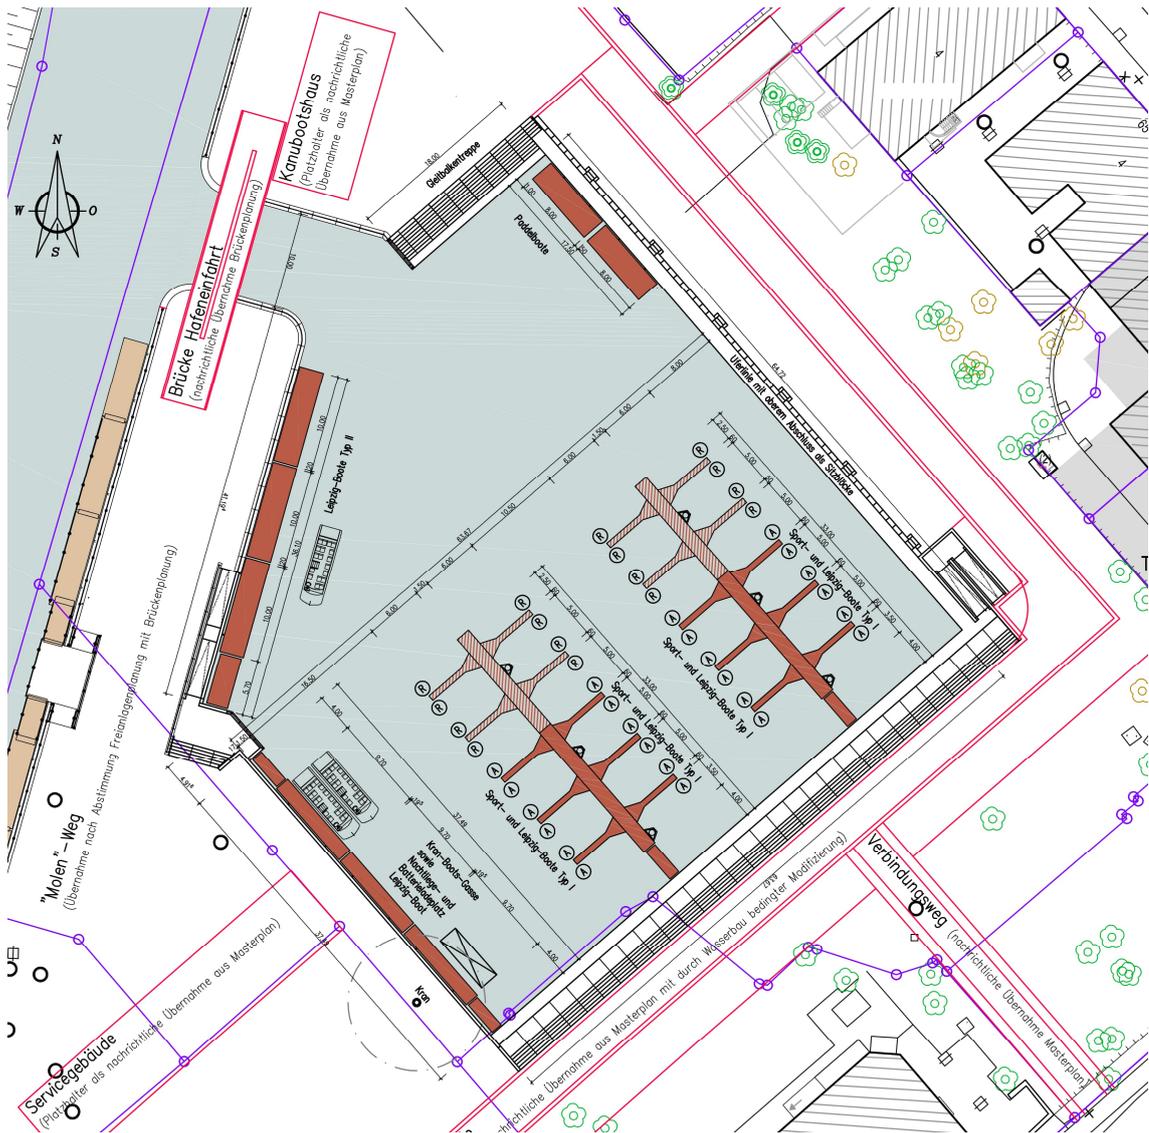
Draufsicht des Hafenbeckens [P1]
